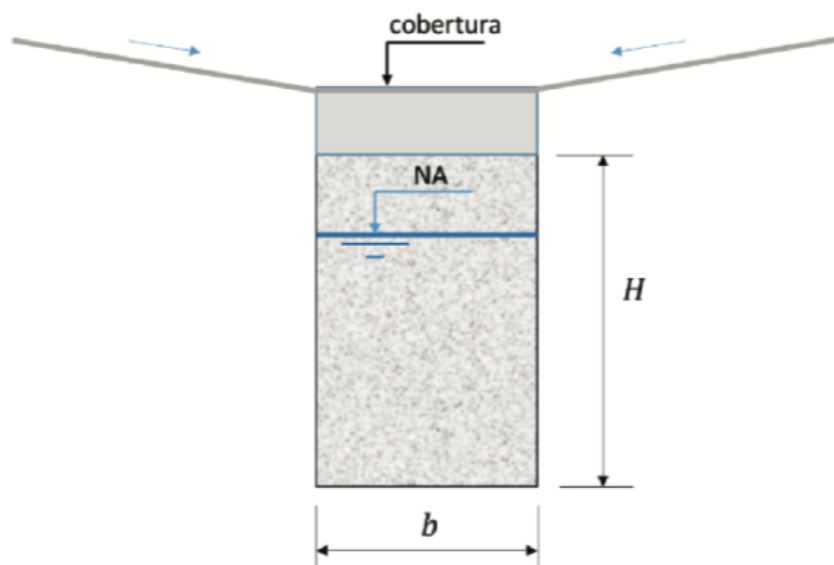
Esquema de configuração de trincheiras de infiltração, corte transversal (ADASA, 2018).
